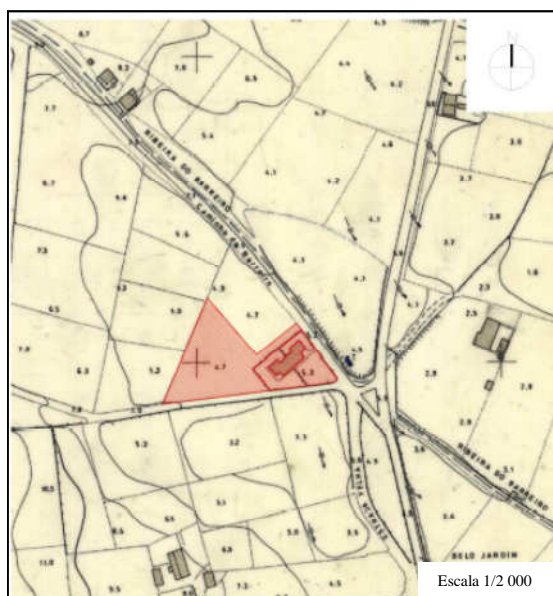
Planta de localização (Projeto de execução, ARQ_02).
